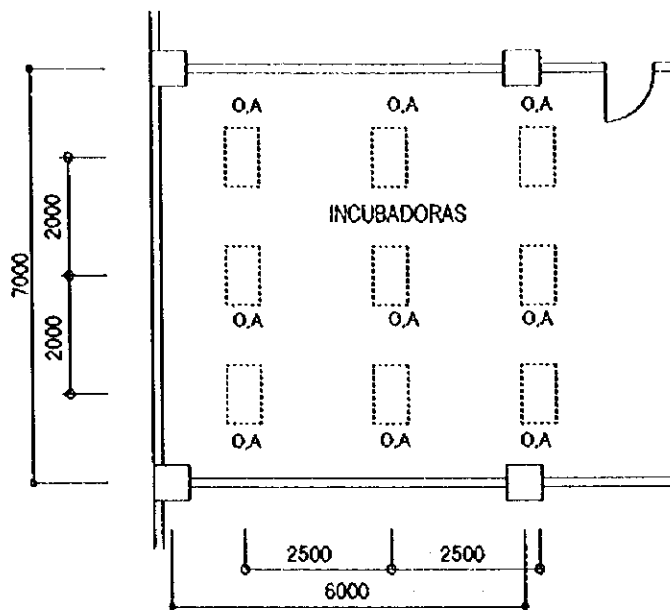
Plano de planta de la distribución de incubadoras en la UCIN
